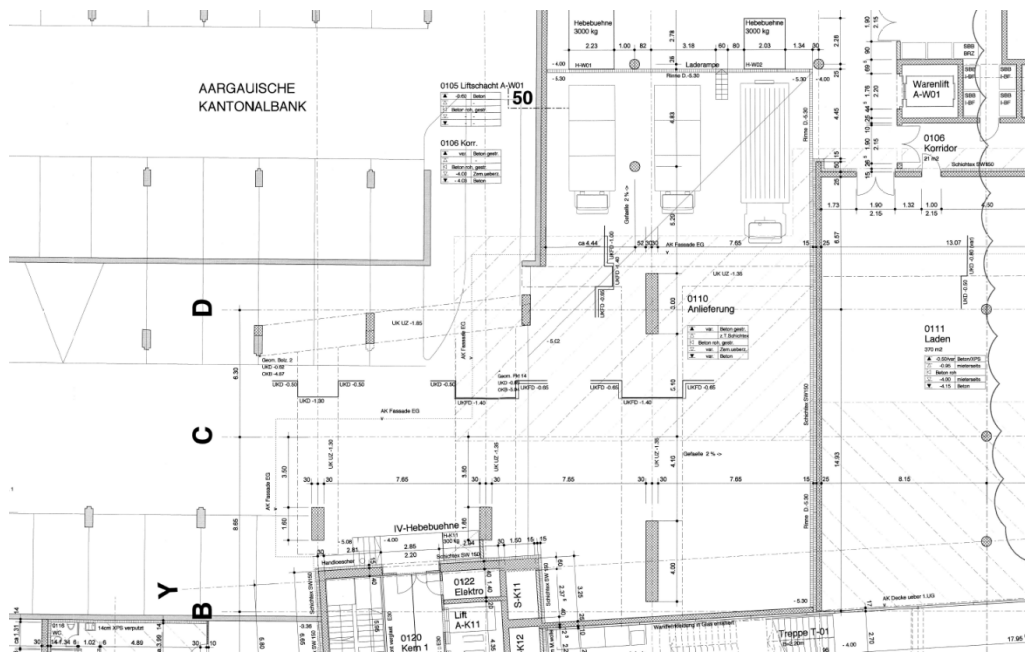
Anlieferungsplätze im 1. Untergeschoss Bahnhof-Parking, Ausschnitt Situationsplan Neubau Bahnhof Aarau, SBB, 13.05.2008
